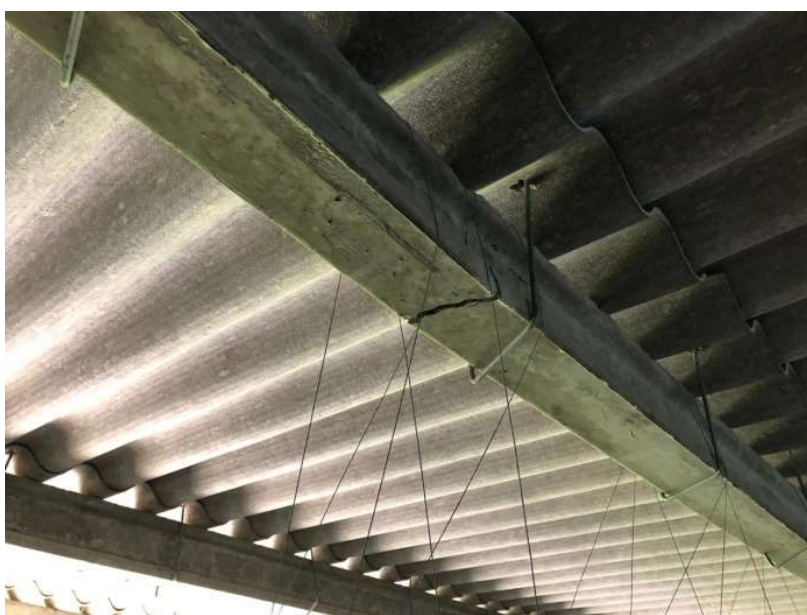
Rachadura na flexão de viga terça vista de baixo
